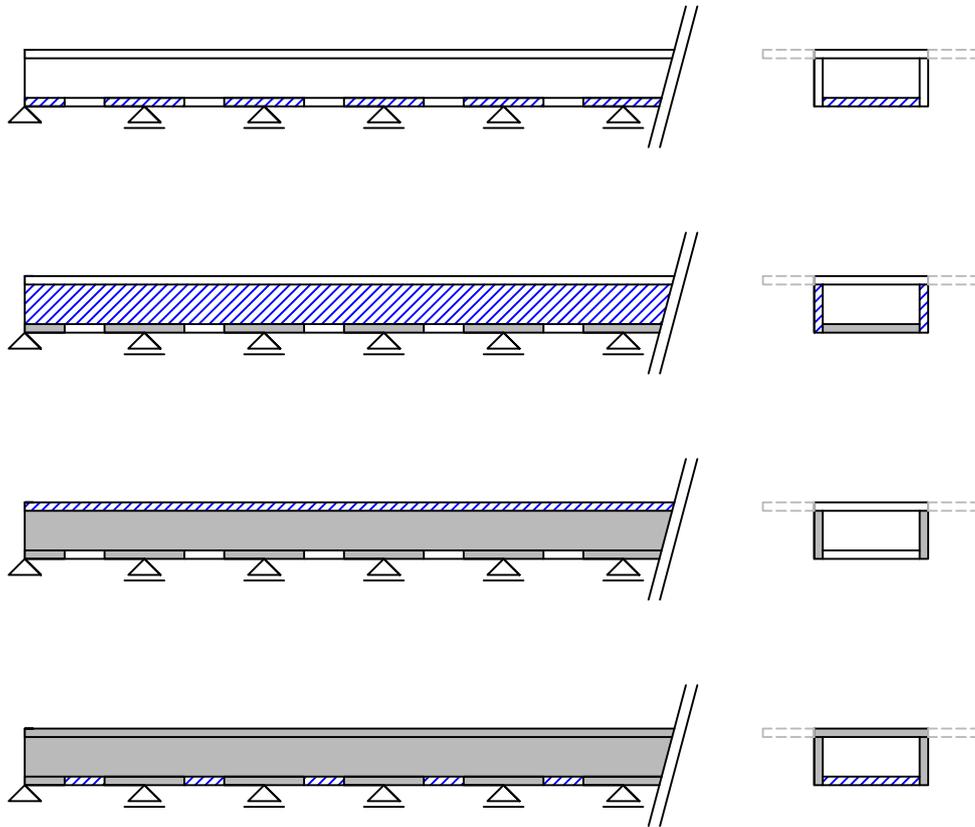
Ablauf des Herstellungsvorganges des fertigen Tragwerkes nach dem Einschub -
